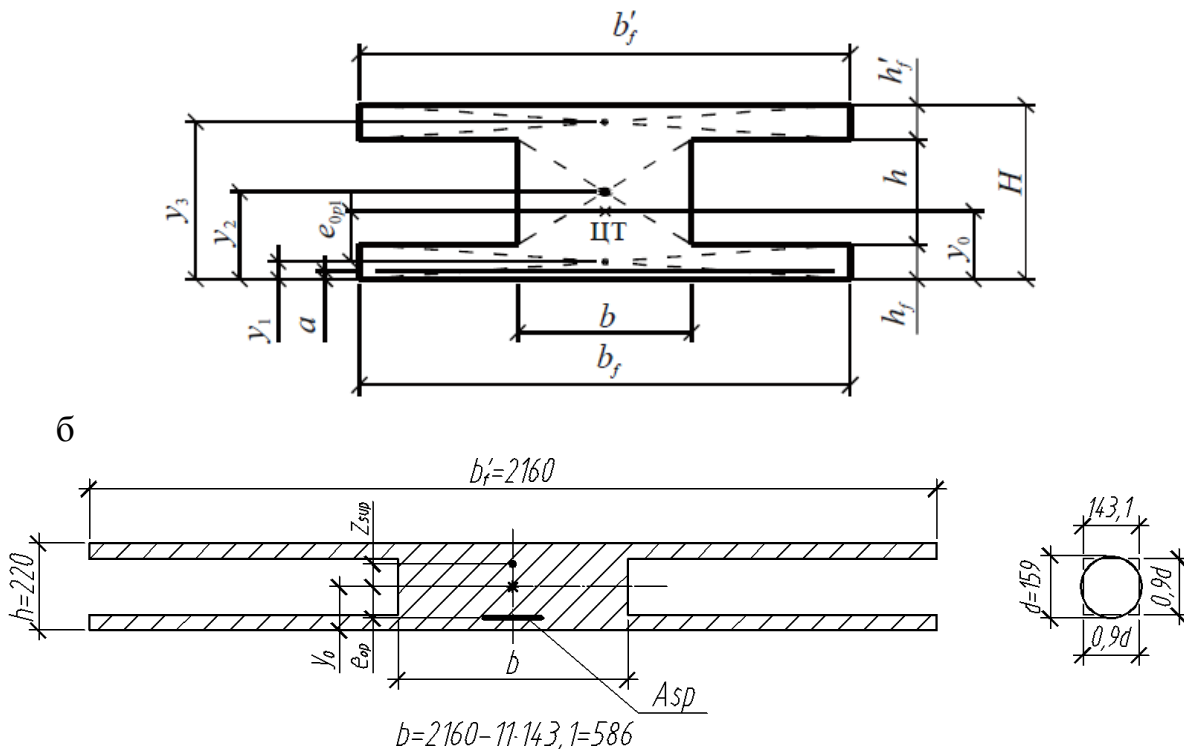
К расчету геометрических свойств сечения (а) и расчетное поперечное сечение плиты при расчете по второй группе предельных состояний (б)
